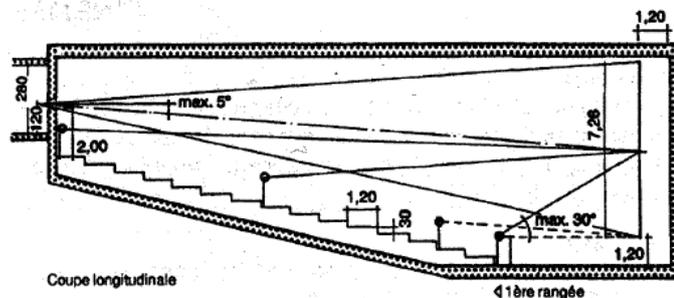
Coupe longitudinale d'une salle de cinéma.
